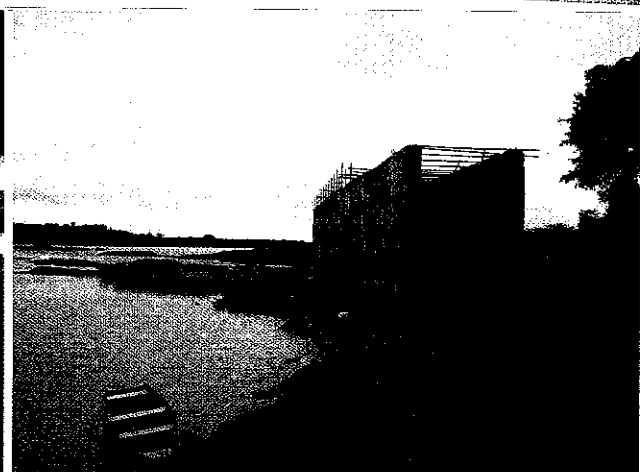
A estrutura possui cerca de 40 metros de comprimento, 4 metros de largura e 6 metros de altura.
